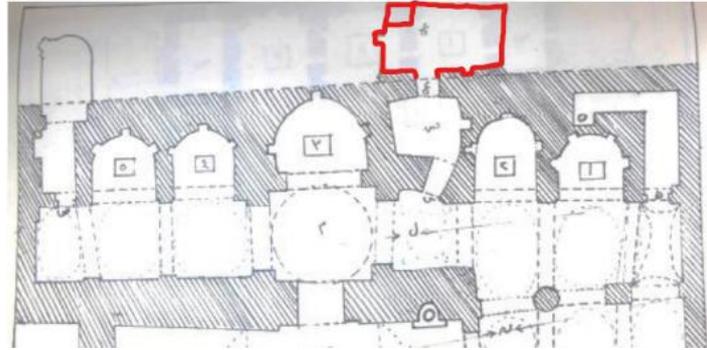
مسقط أفقي لكنيسة الست دميانة بأخميم، عن: عاطف سعد، دراسة مقارنة بين المساجد والكنايس، ص ٥٧.
